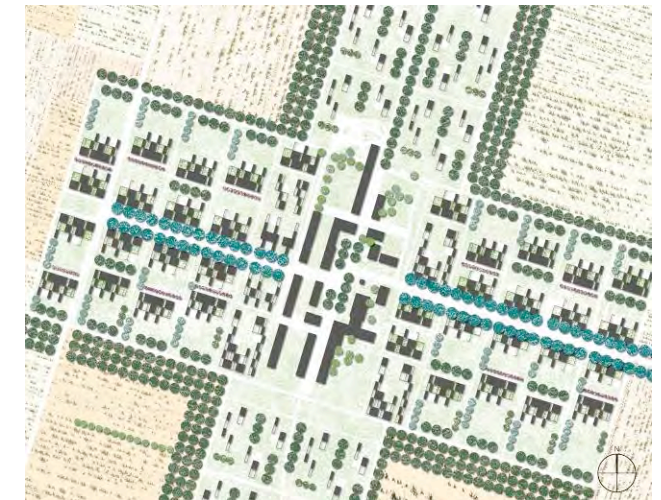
Segezia – Planimetrie e sezione delle funzioni.
